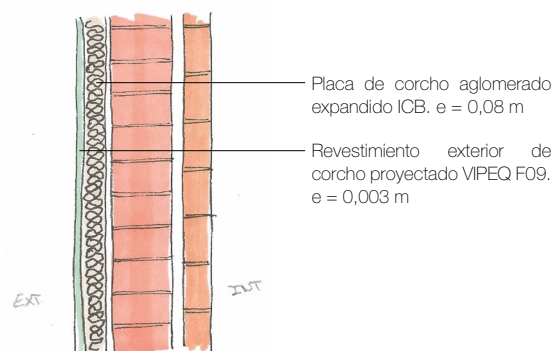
Sistema SATE aplicado en el cerramiento de fachada. Boceto realizado por la autora.
